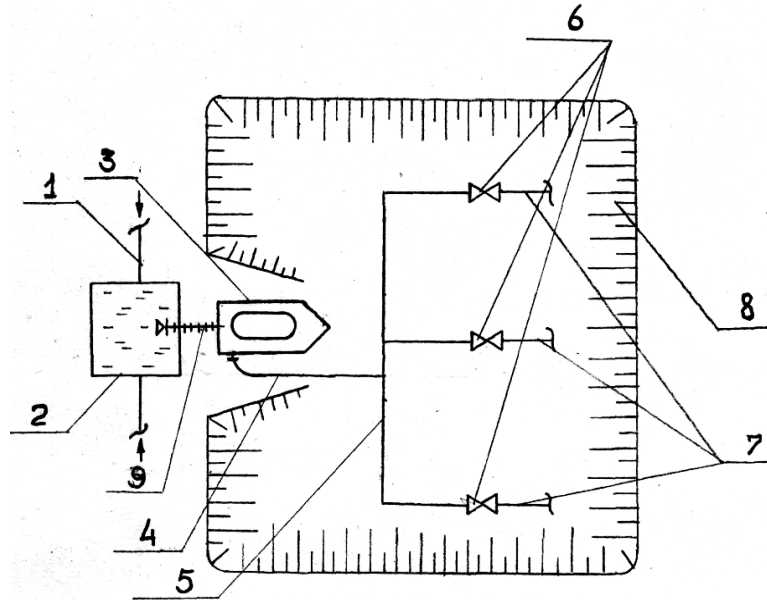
Схема захисного капоніру: 1 - з'єднувальні трубопроводи з сусідніми водіймами; 2 – водійма; 3 – стаціонарна насосна установка (пересувна пожежна техніка); 4 – трубопровід підключення (пожежний рукав); 5 - розподільчий трубопровід (колектор); 6 - вентилі розподільчого вузла; 7 - трубопровід до дренчерної системи; 8 - захисний капонір
